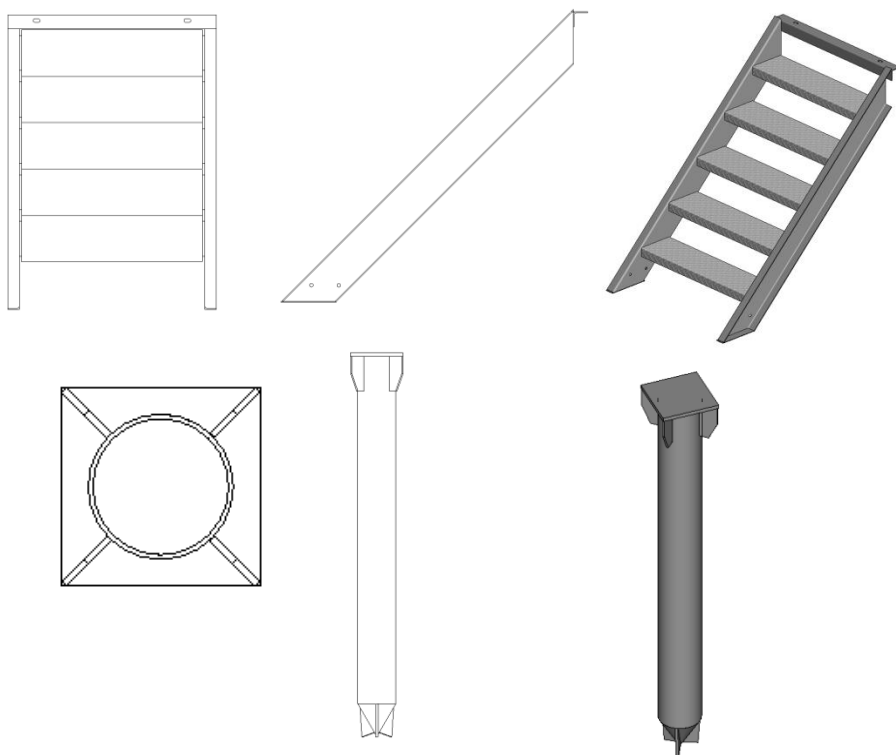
Лестница: вид сверху, сбоку и 3D;
